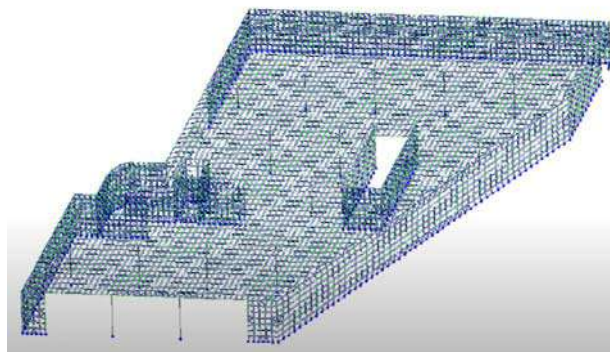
Расчетная модель железобетонного перекрытия сложного контура в ПК «ЛИРА-САПР»
